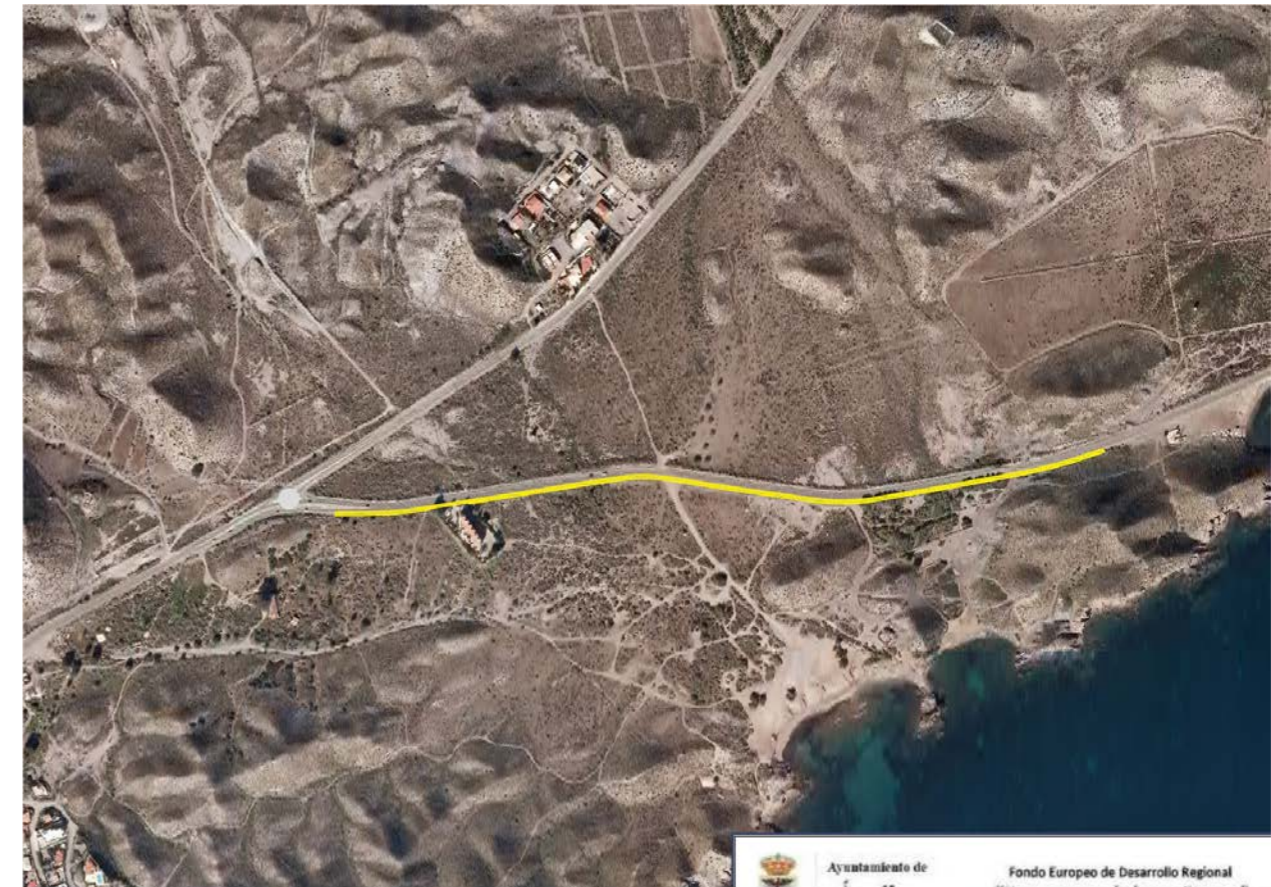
Plano situación del carril bici en ejecución. (Fuente: Proyecto de carril bici junto a la carretera RM-D15 tramo P.K. 0+025 al 0+923).
